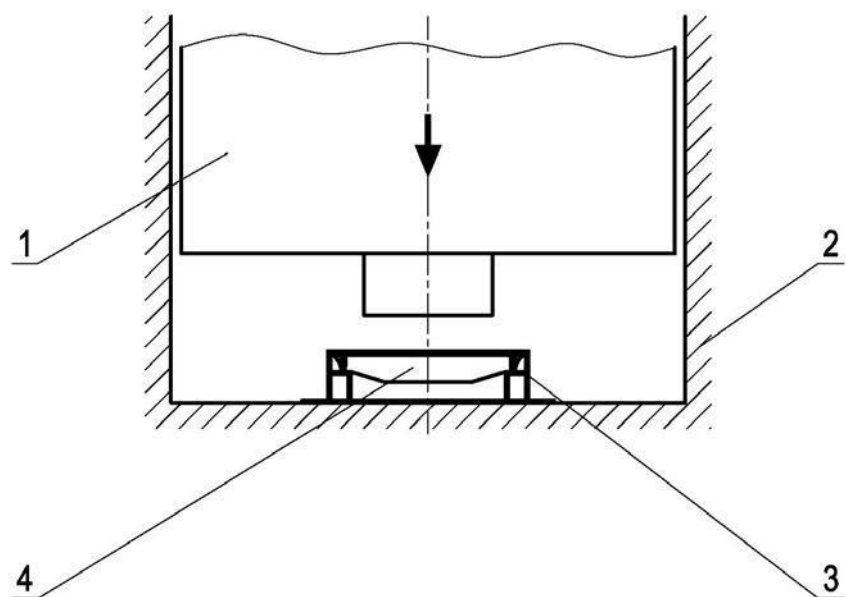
Схема испытаний лотков металлических серии "Bridge", "Bridge-Light" и Bridge W-canal на класс нагрузки (1 – ползун пресса, 2 - станина пресса, 3 – испытываемый лоток, 4 – водоприемная решетка).
